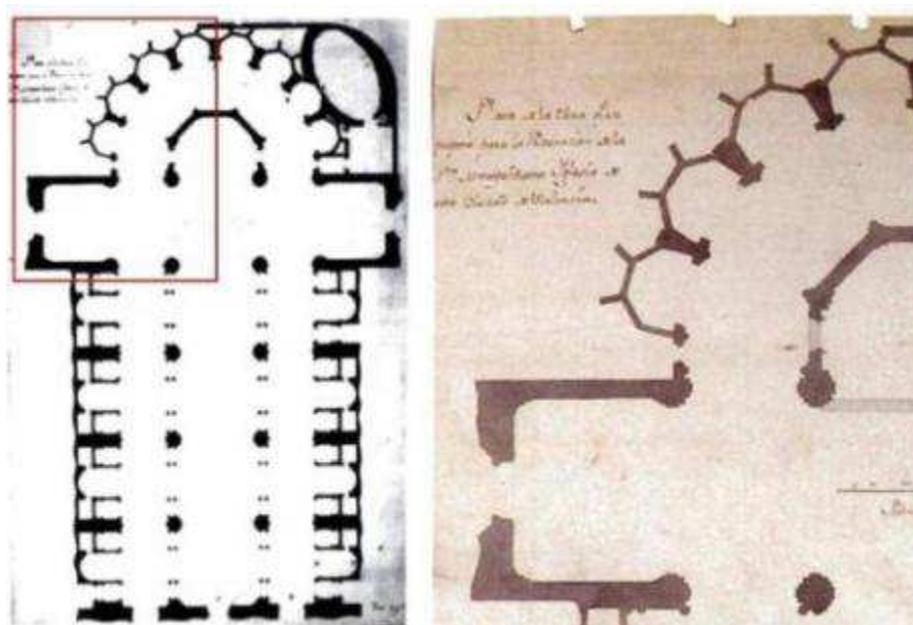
15.5 Plano de la obra que propone Vicente Gascó en su proyecto para la remodelación de la catedral (ca.1773). A la derecha, detalle de la zona que afectaría a la escalera.
